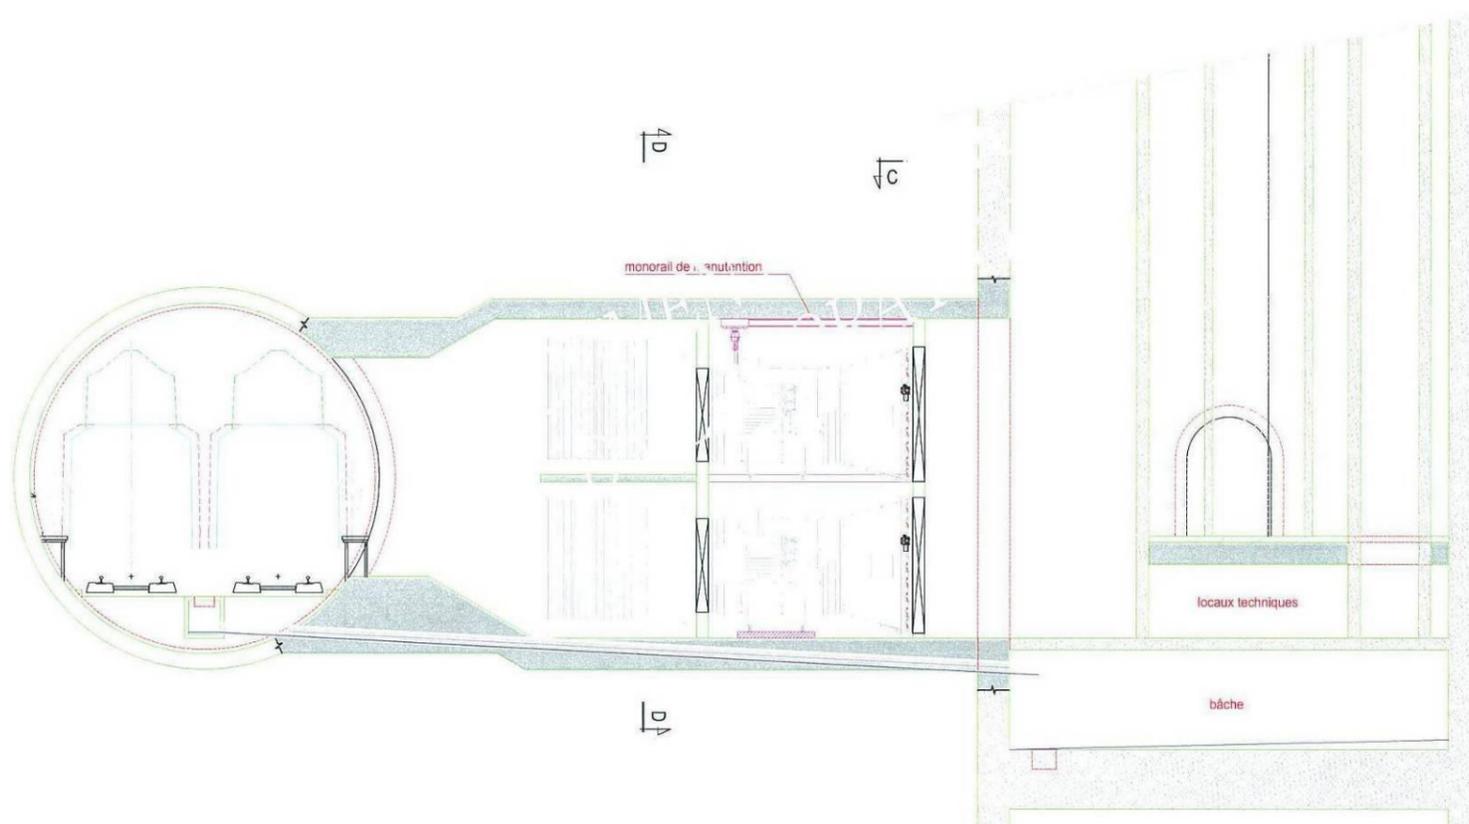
Schéma de principe d'un puits de ventilation et d'accès secours - vue en coupe plan vertical - Source SETEC-Etudes préliminaires
